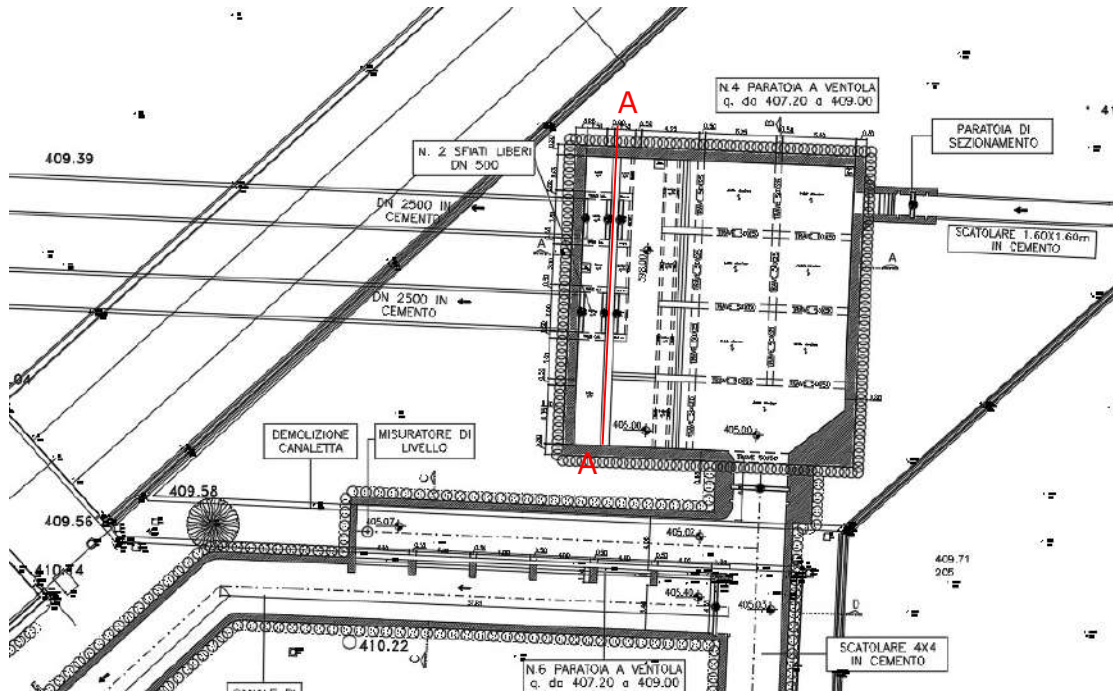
Posizione della sezione di calcolo delle opere provvisori
